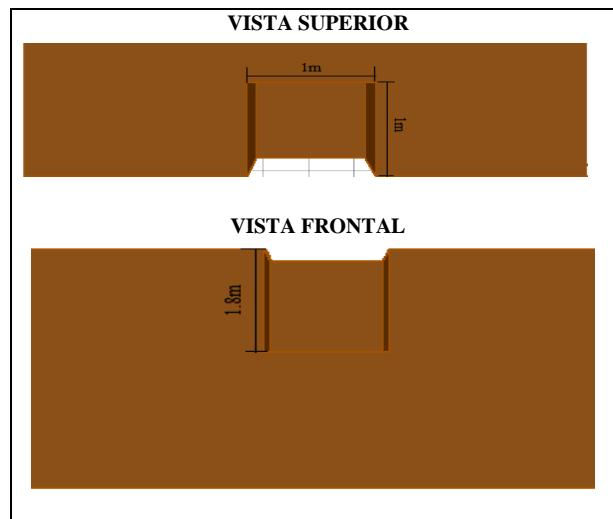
dimensiones de la técnica de apique (vista superior – vista frontal)
